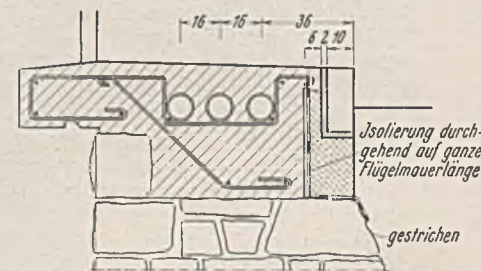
Schnitt durch die Flügelmauer aus Bruchstein mit Schrammbordstein. Isolierung durchgehend auf ganze Flügelmauerlänge gestrichen
